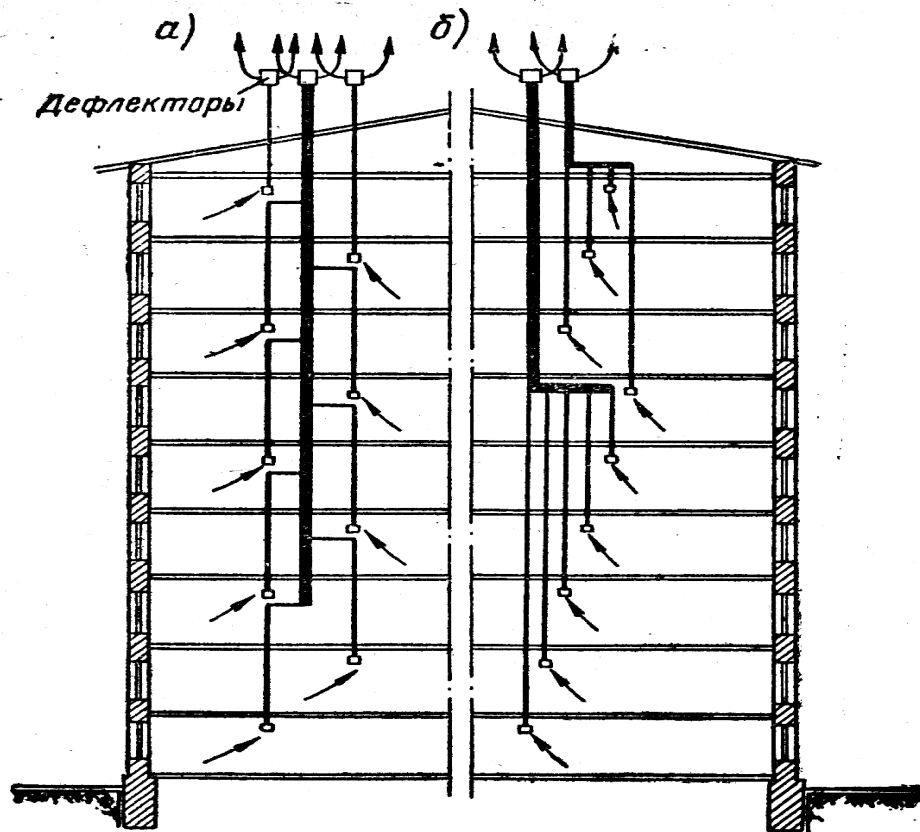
Схема вытяжной канальной вентиляции трехэтажного дома
